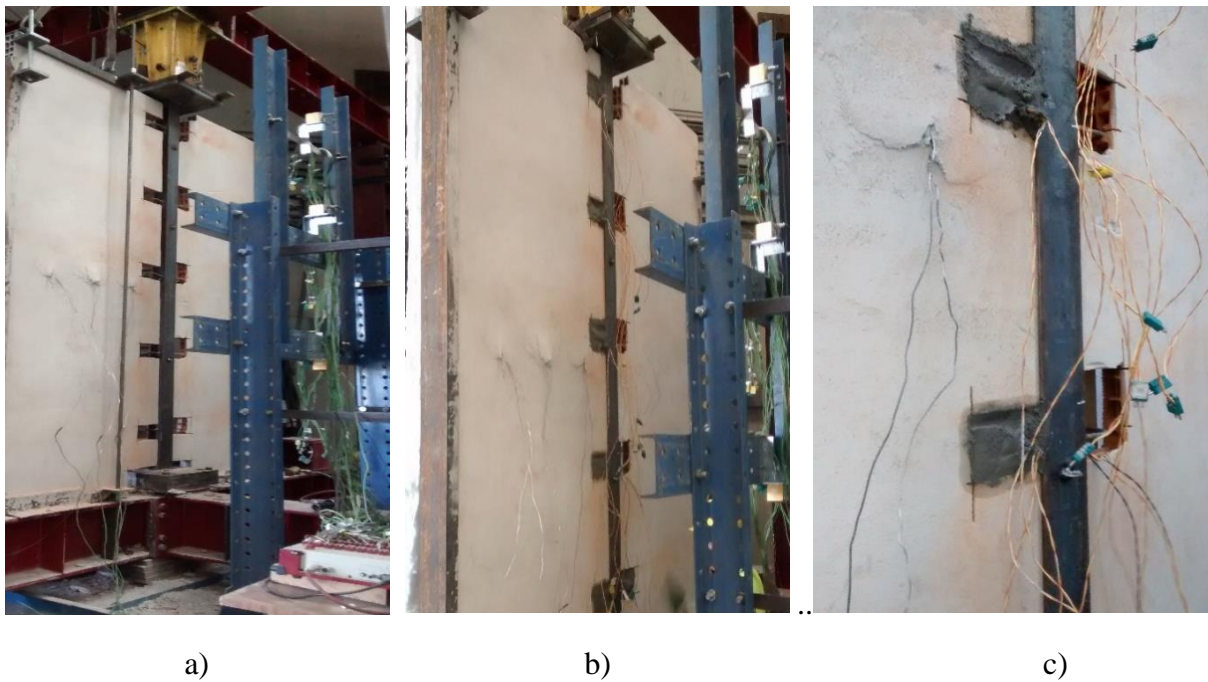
Pormenores de ligação entre as paredes, o pilar com a alma perpendicular às mesmas e o pórtico a) rasgos para posterior ancoragem da parede à coluna de teste b) ligação pilar – parede c) ancoragem da ligação pilar – parede
